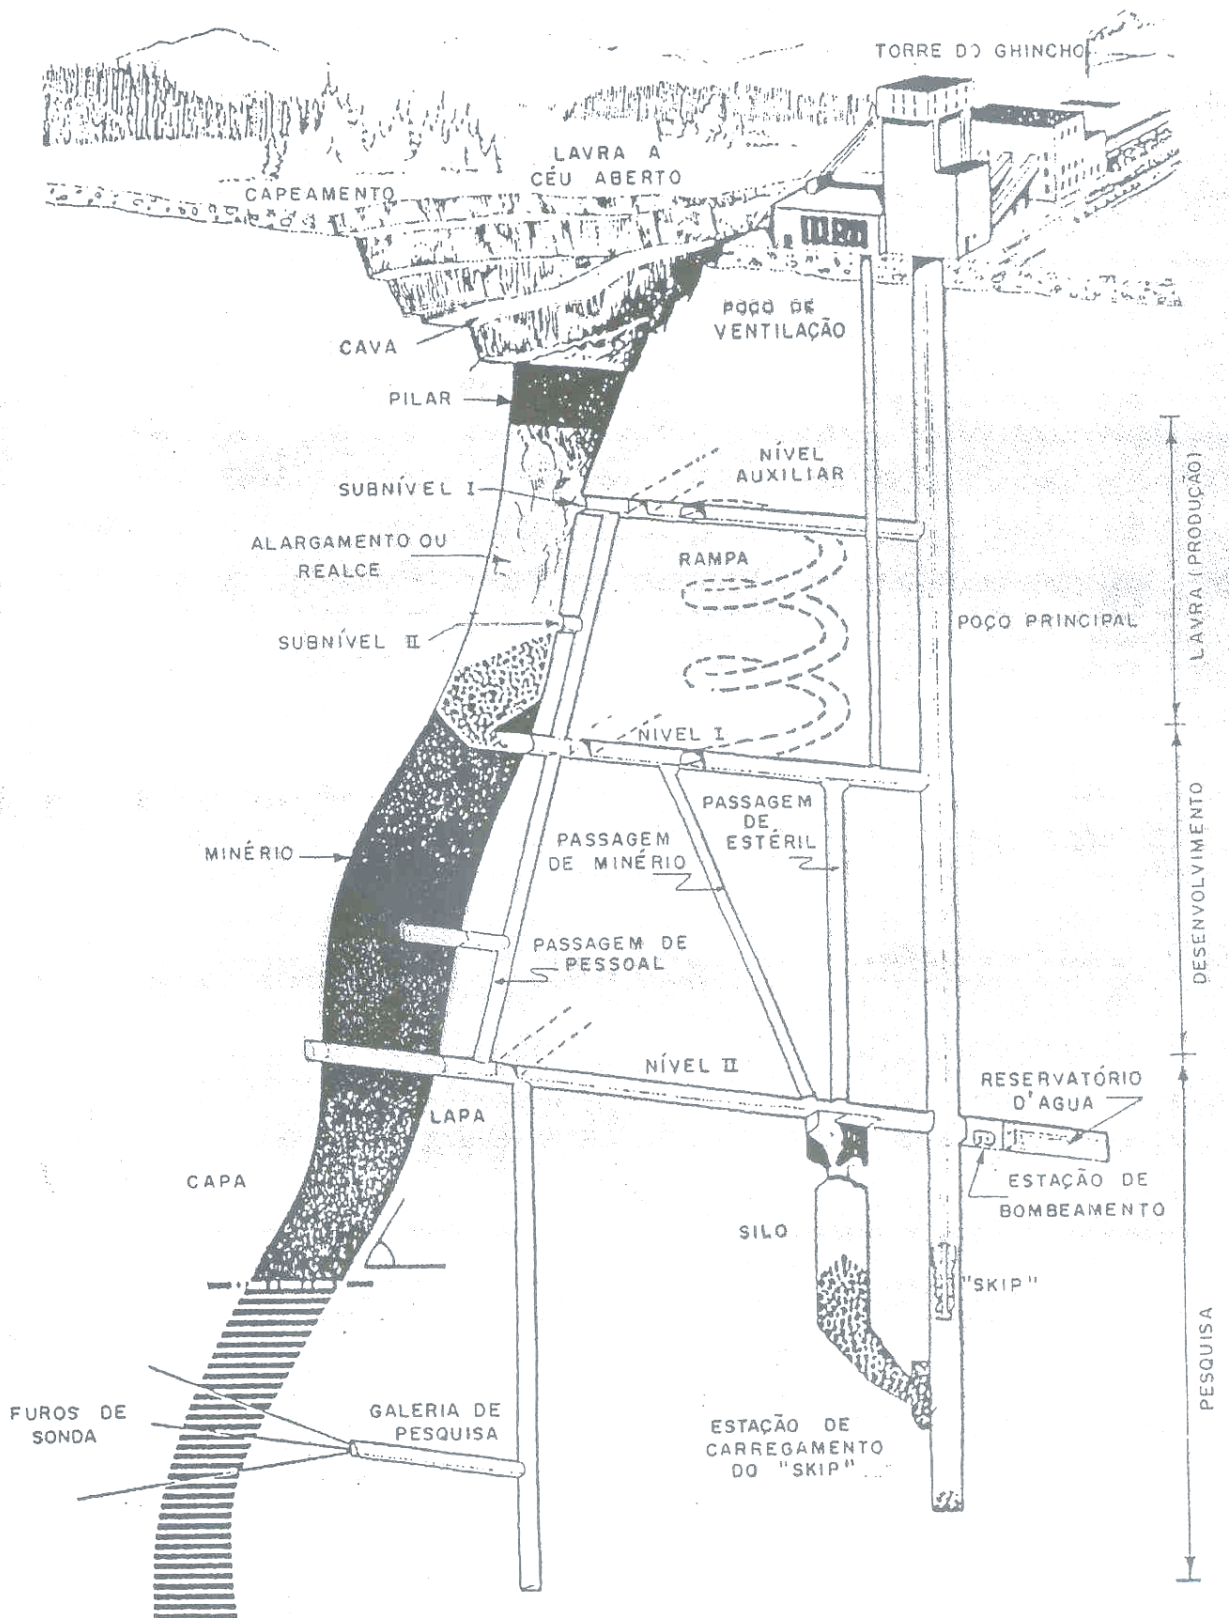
Arranjo geral esquemático. Mina subterrânea.
